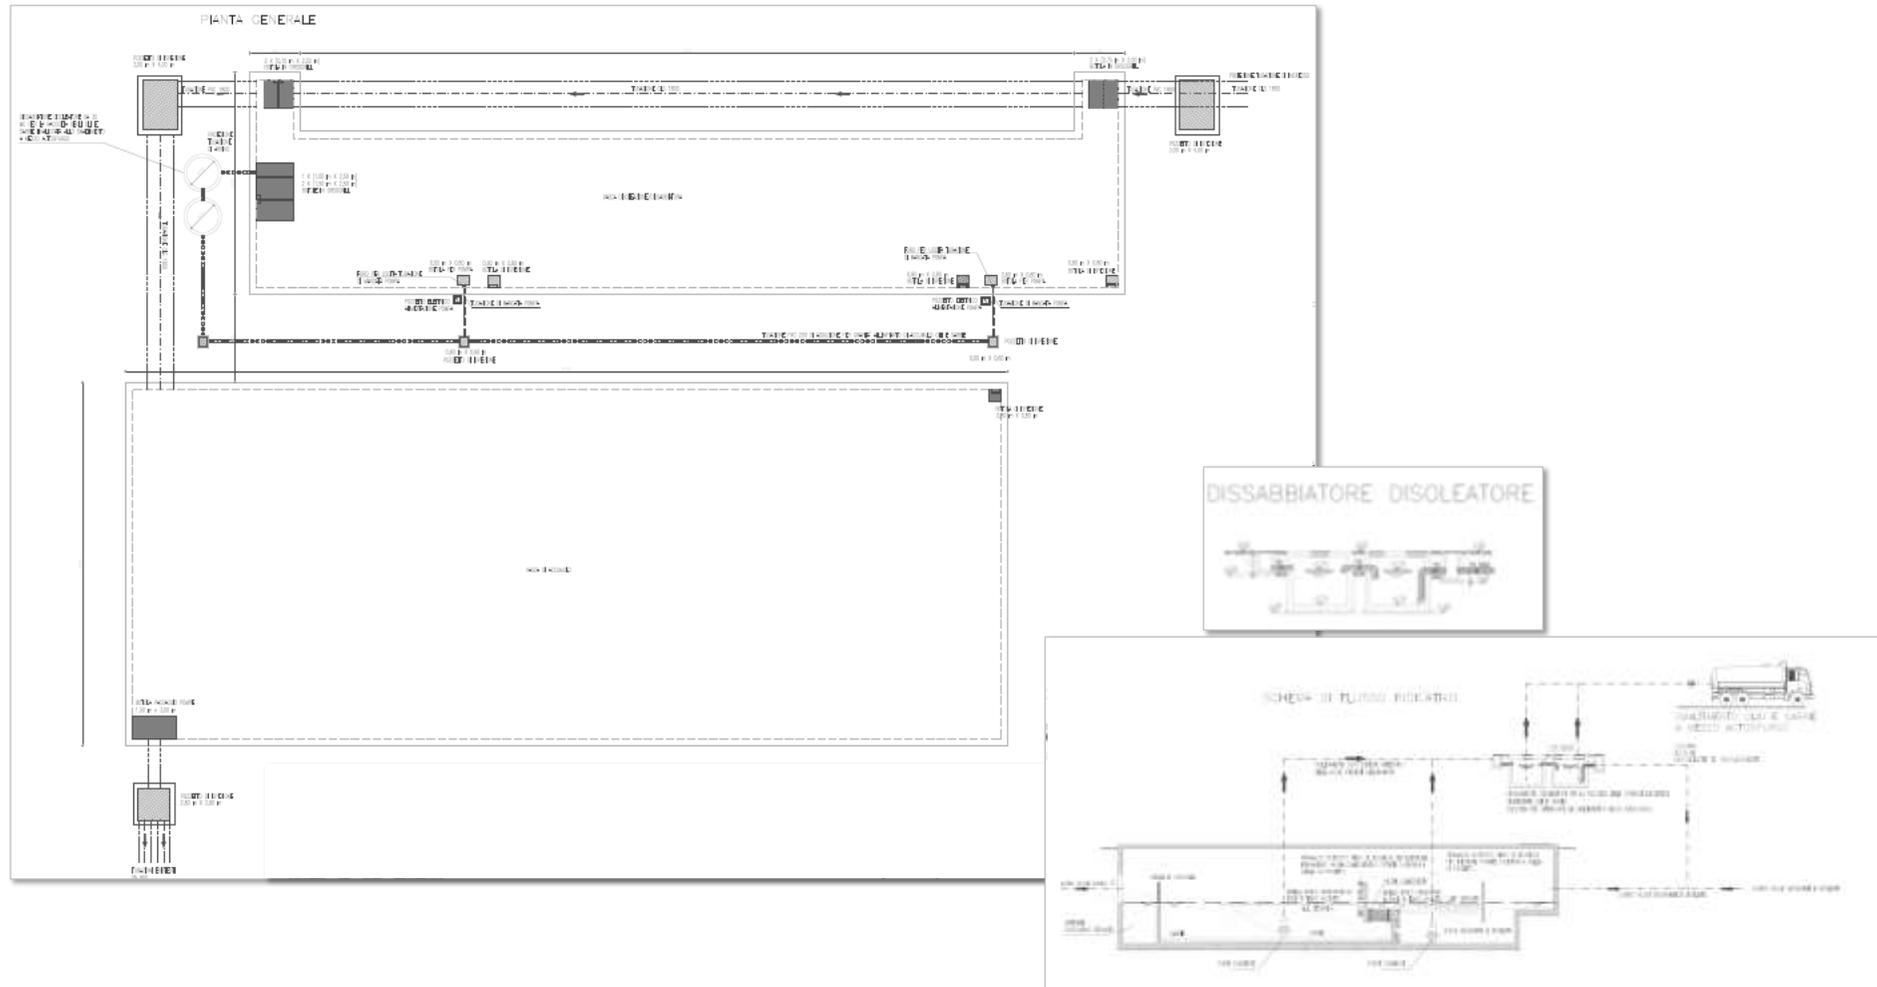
Sistema di raccolta e smaltimento acque meteoriche Impianto di trattamento e accumulo zona "C" - Pianta generale e schema di flusso
